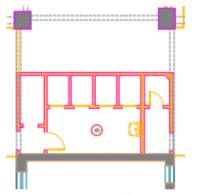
Planta de demolição - localização no Banheiro existente (2ºpavimento)
